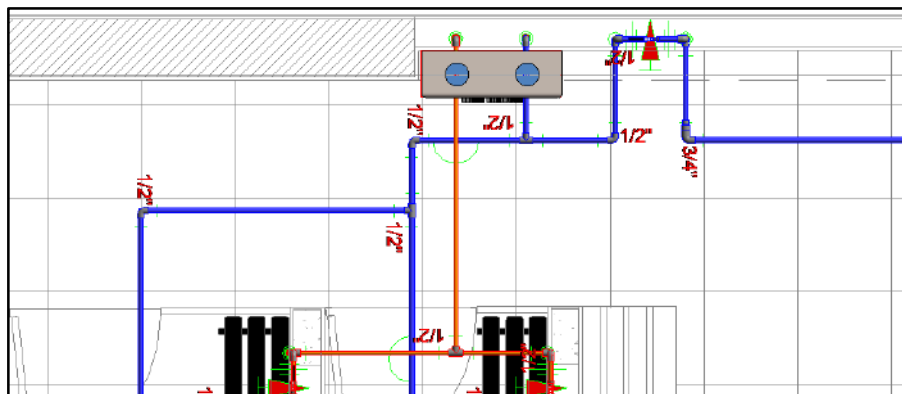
Vista en planta del plano del Pabellón E donde se muestra que los puntos de agua caliente y agua fría están en lados opuestos
